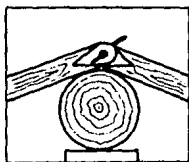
DETALLE DE LA UNION VIGA-VIGA-TRAVESAÑO EN UNA CASA TIPICA DE AYUTLA, GRO.
